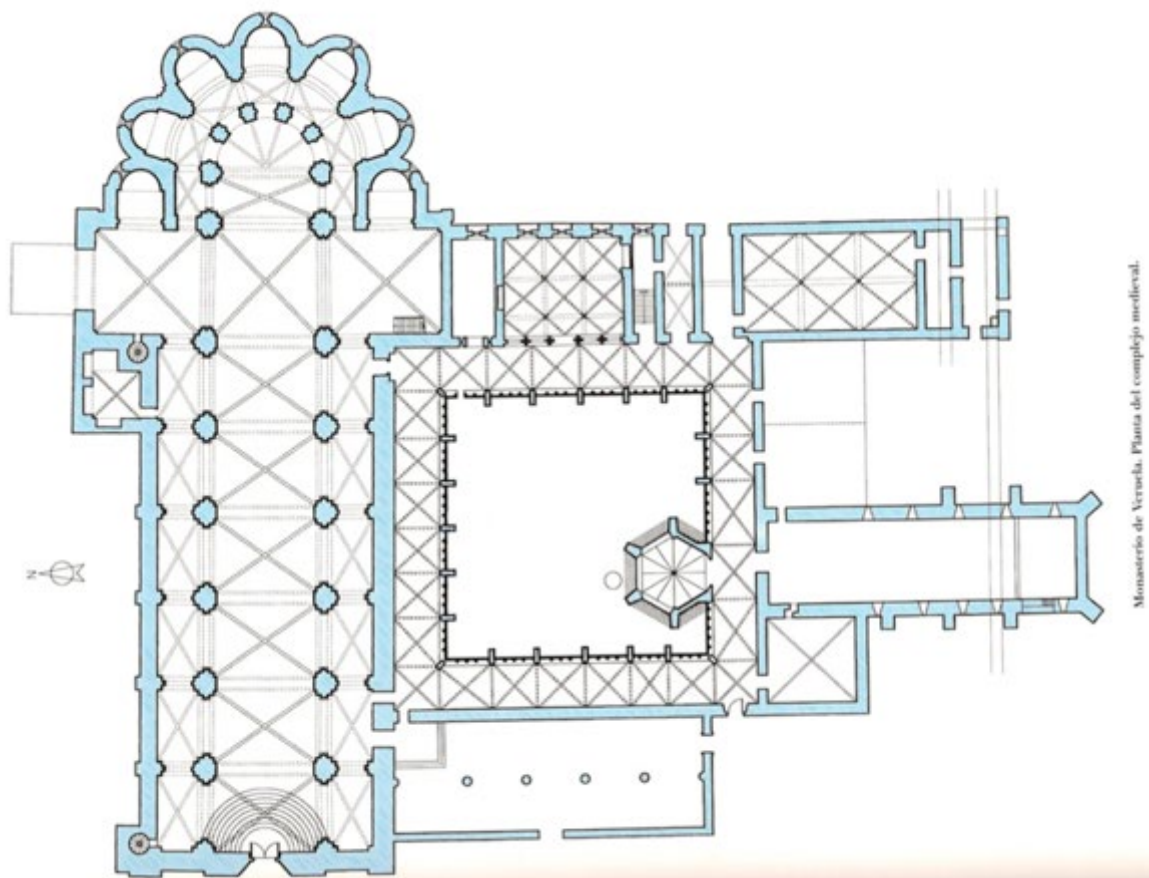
Veruela, Santa María, Grundriss mittelalterliche Gesamtanlage, 12.-16. Jhdt.
